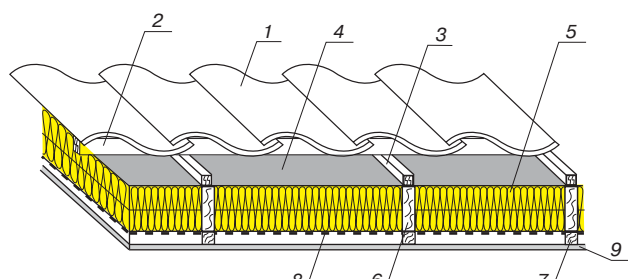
Схема устройства теплоизоляции мансарды с несущим каркасом, расположенным непосредственно в утеплителе: 1 – кровельное покрытие; 2, 3, 7 – контробрешетка; 4 – гидроизоляционная паропроницаемая мембрана Tyvek Soft; 5 – теплоизоляция ISOVER СкатнаяКровля; 6 – стропила; 8 – пароизоляция; 9 – внутренняя отделка
